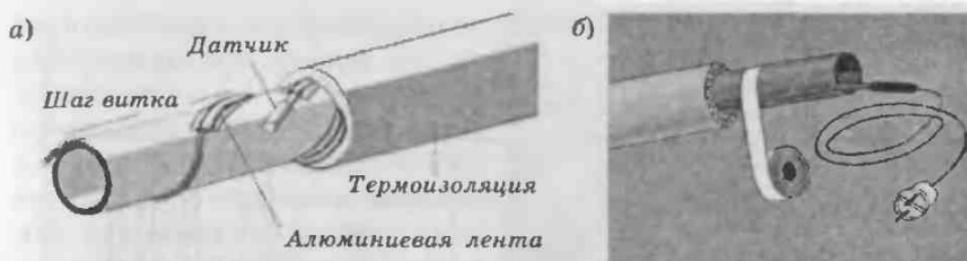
Укладка обогревающего кабеля: а — витками; б — по длине
